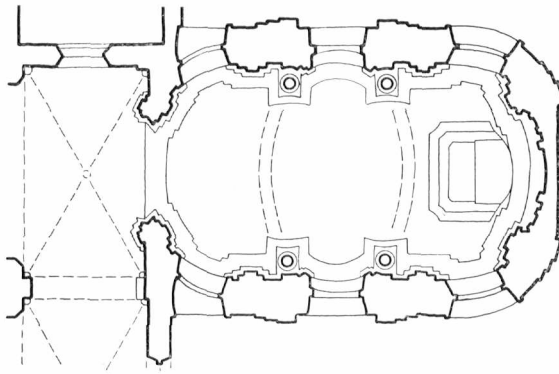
Breslau. Hochbergkapelle. Grundriß 1:300
